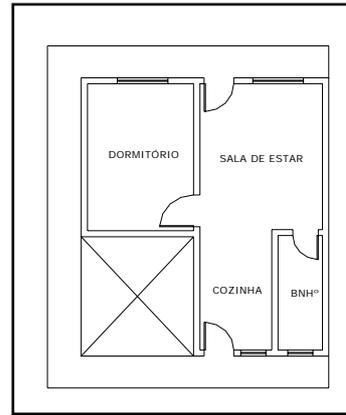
Planta Baixa da casa proposta pelo projeto. Fonte: levantamento feito no local
